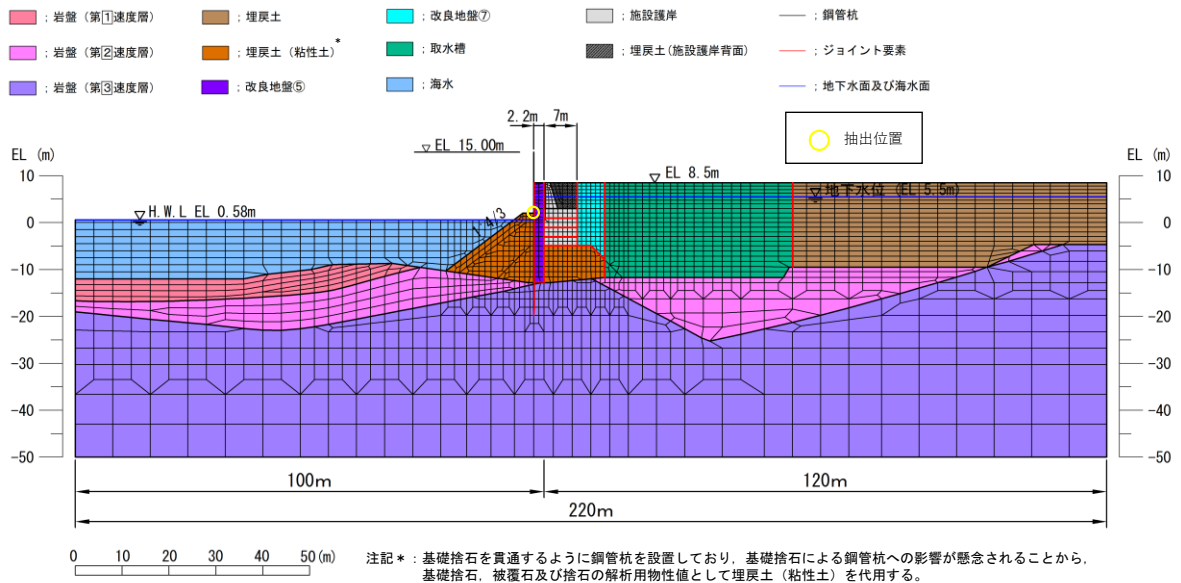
(2) 鋼管杭変位の抽出位置 (④-④断面)
